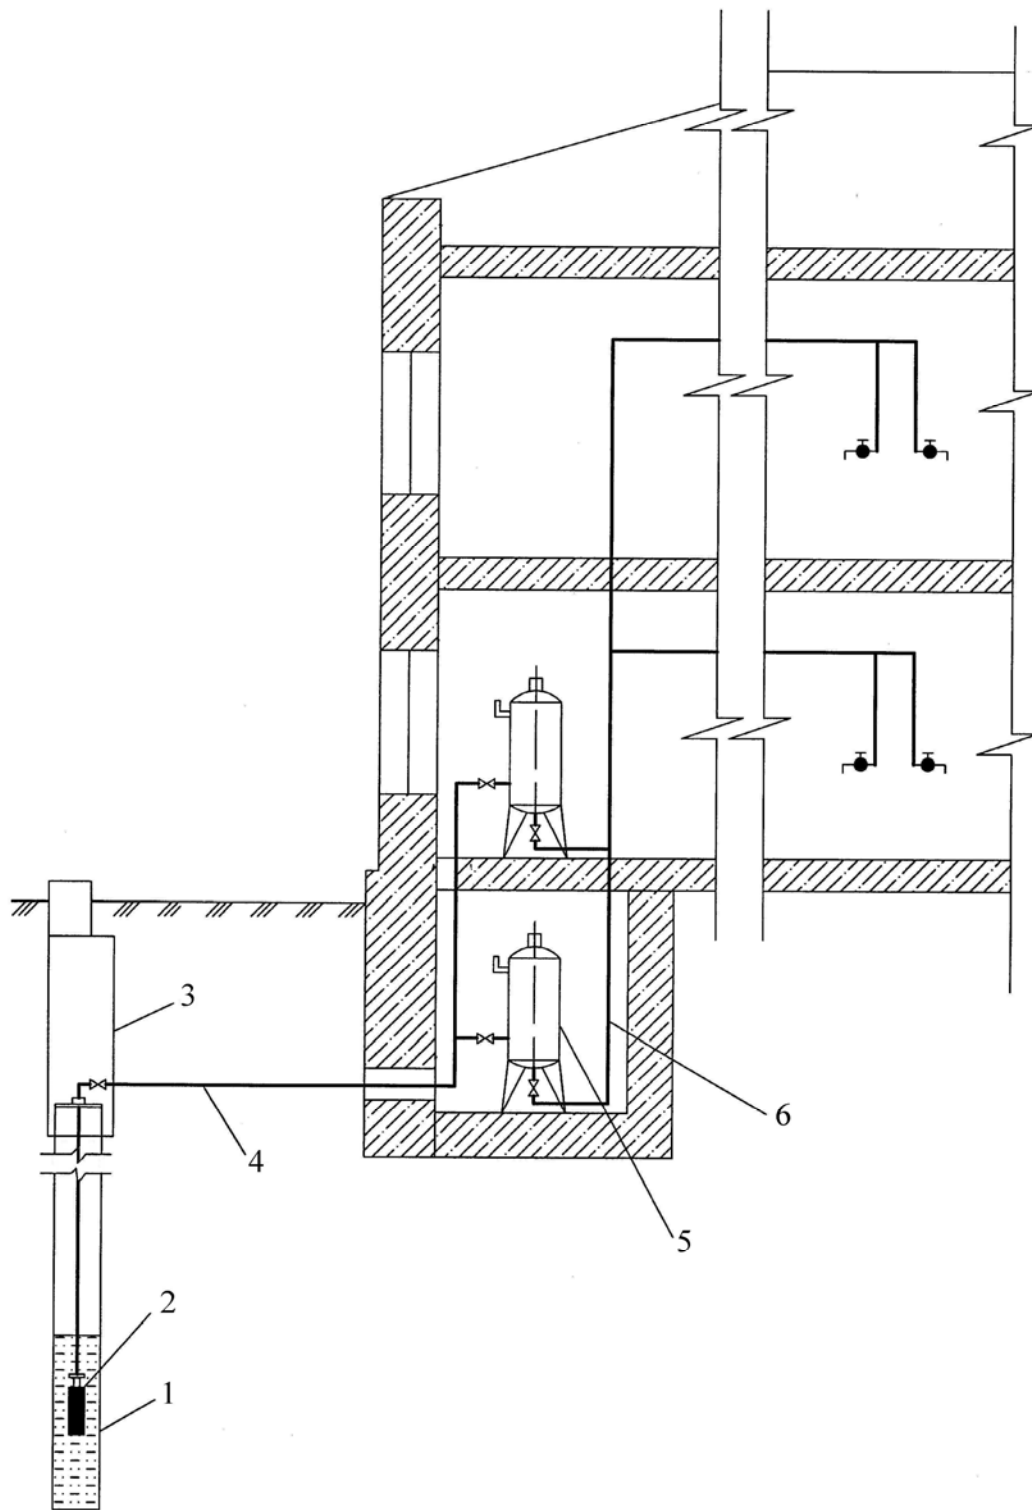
Схема водоснабжения из скважины с гидропневмобаком:
